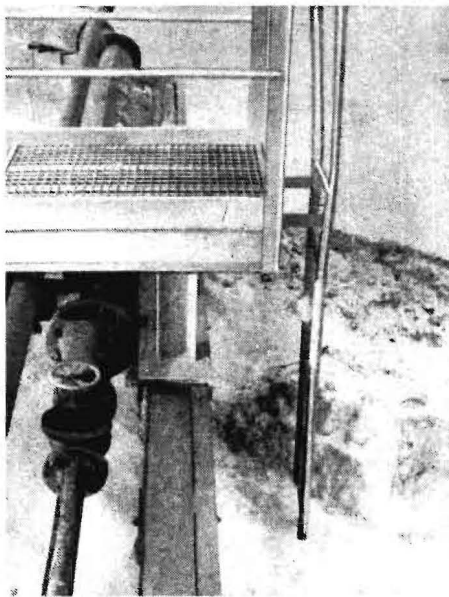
Betonwand mit umlaufendem Profil und Auflager des Laufstegs
